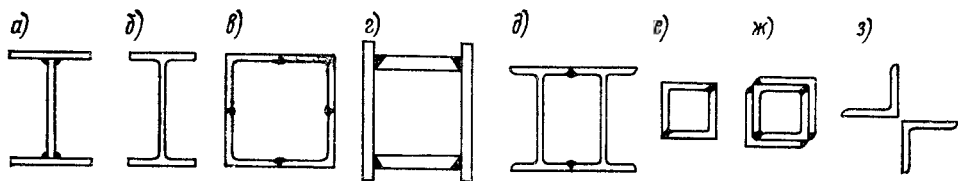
Сечение колонн многоэтажных производственных зданий и промышленных этажей
